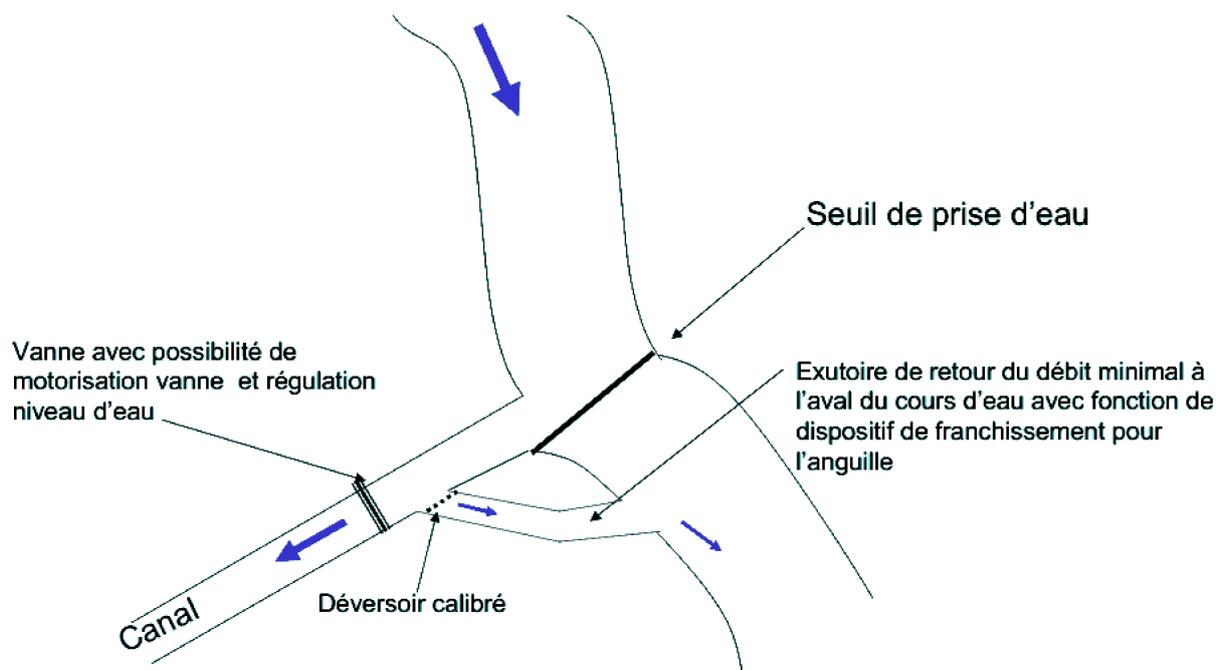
Schéma type d'aménagement d'un dispositif de restitution du débit minimal (Extrait de BARIL, 2014)
